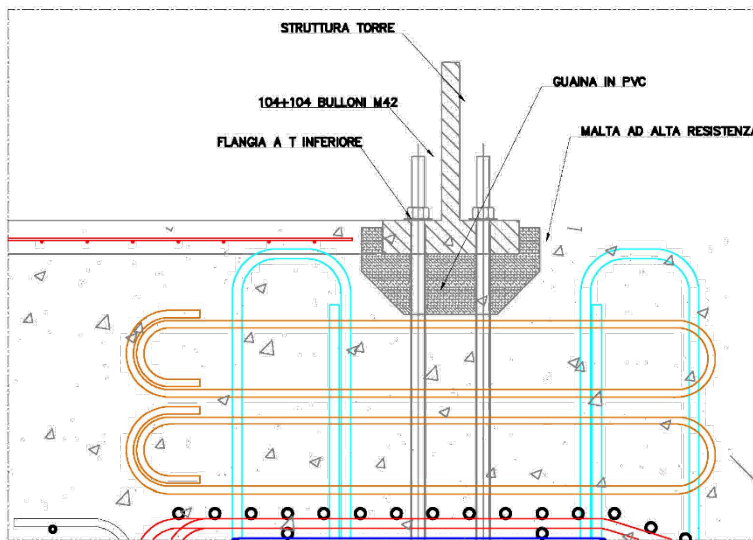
Rif. Elaborato F.2 - schema rappresentativo della fondazione tipo
